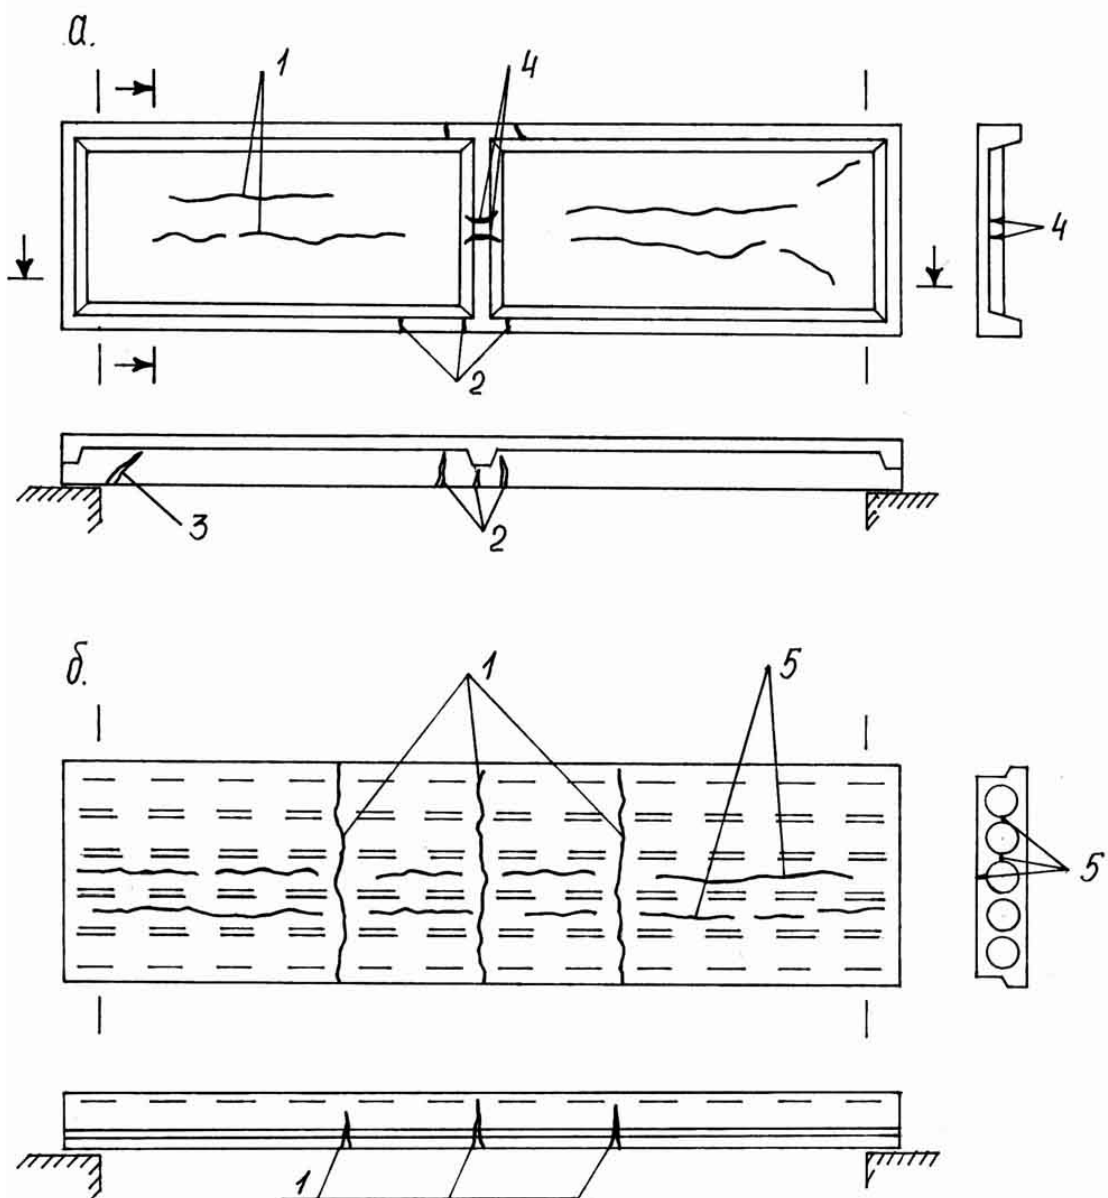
Трещины в сборных панелях перекрытий:
